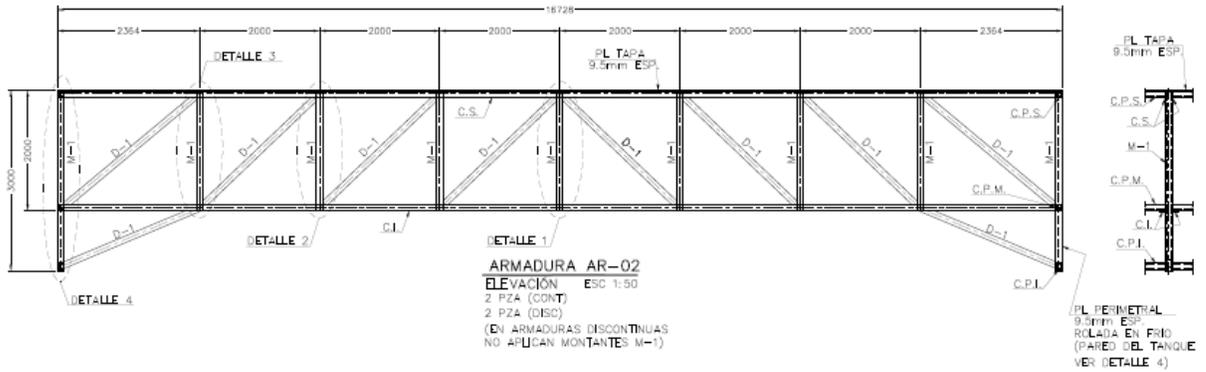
Perfil de armadura tipo AR-02 para tanque de flotación.
